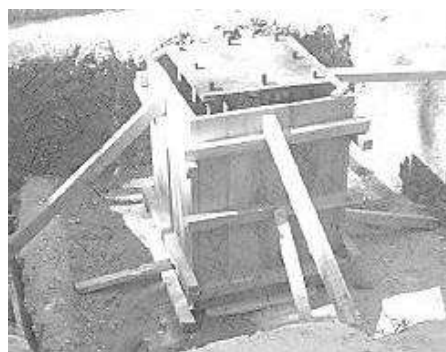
Encofrado del pedestal para la columna. Fuente: Google (marzo 2011)
